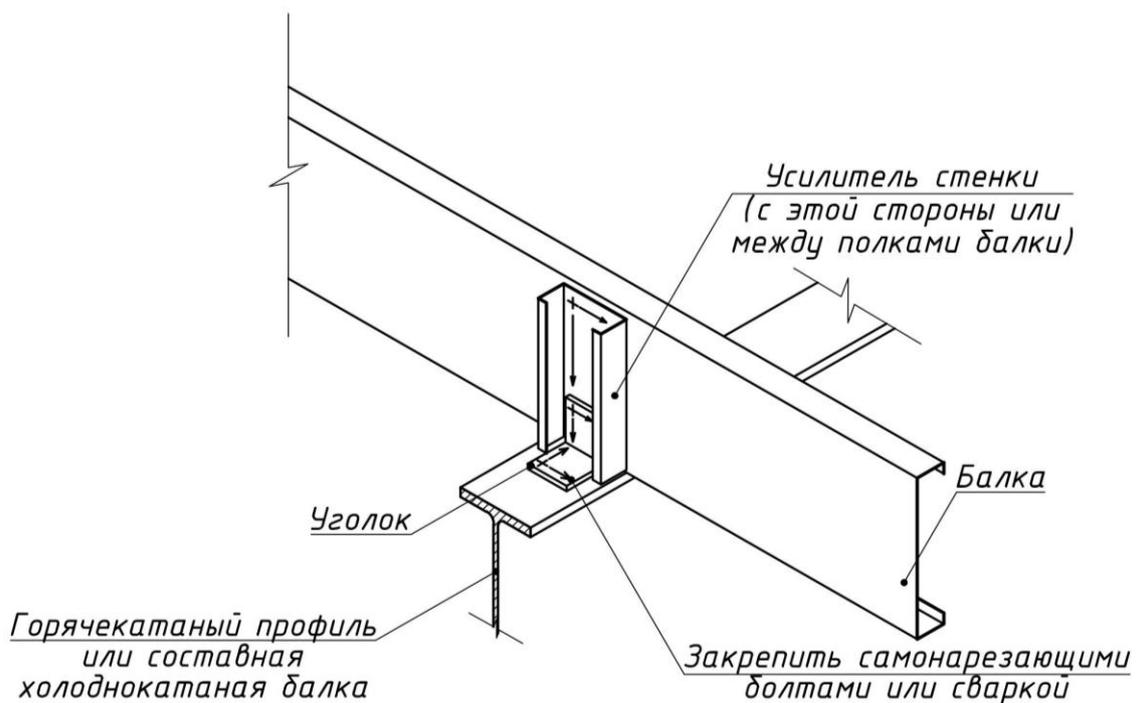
Узел П 5. Крепление перекрытия к горячекатаному профилю
